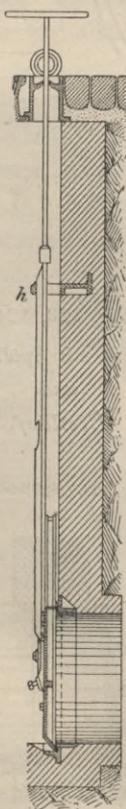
, 127. Gußeiserner Handschieber nach Geiger.
